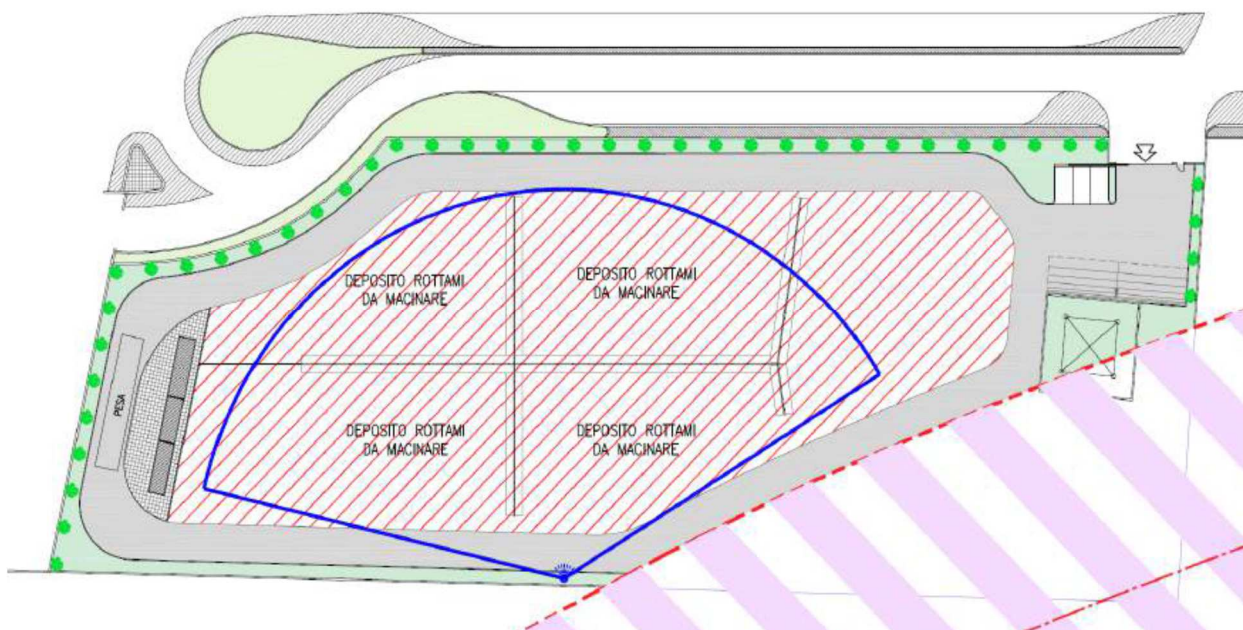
Schema planimetrico posizionamento e funzionamento sistema antipolvere
